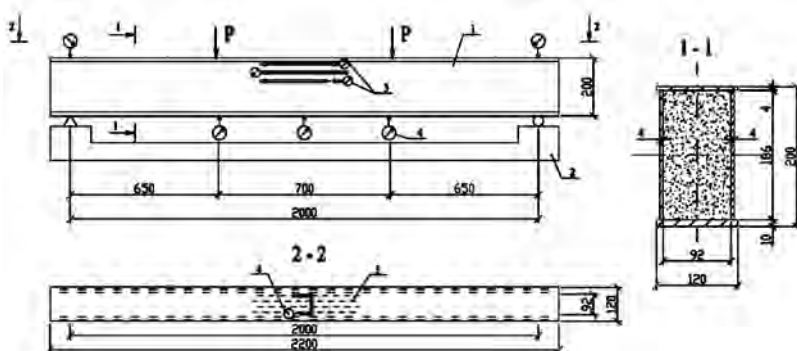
Конструкция сталебетонной балки и схема ее нагружения
